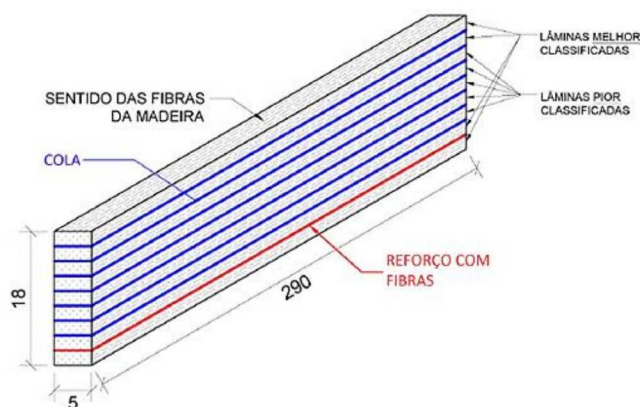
Esquema de montaje de las vigas probadas – fuente: Saldanha (2018).
